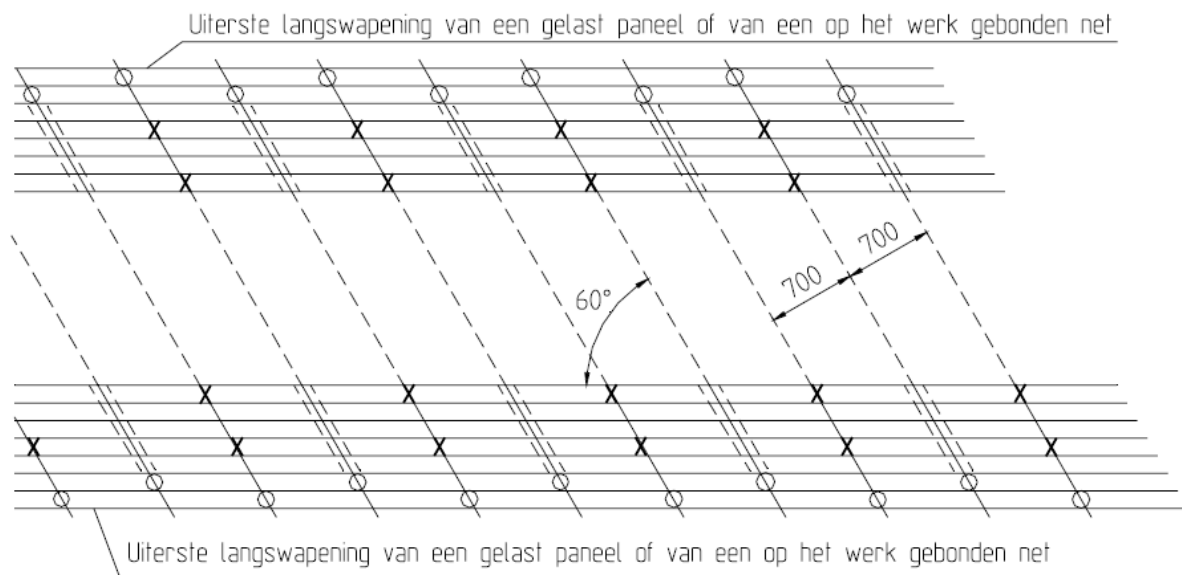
Wapeningsplan doorgaand gewapend beton (alle maten in mm)
